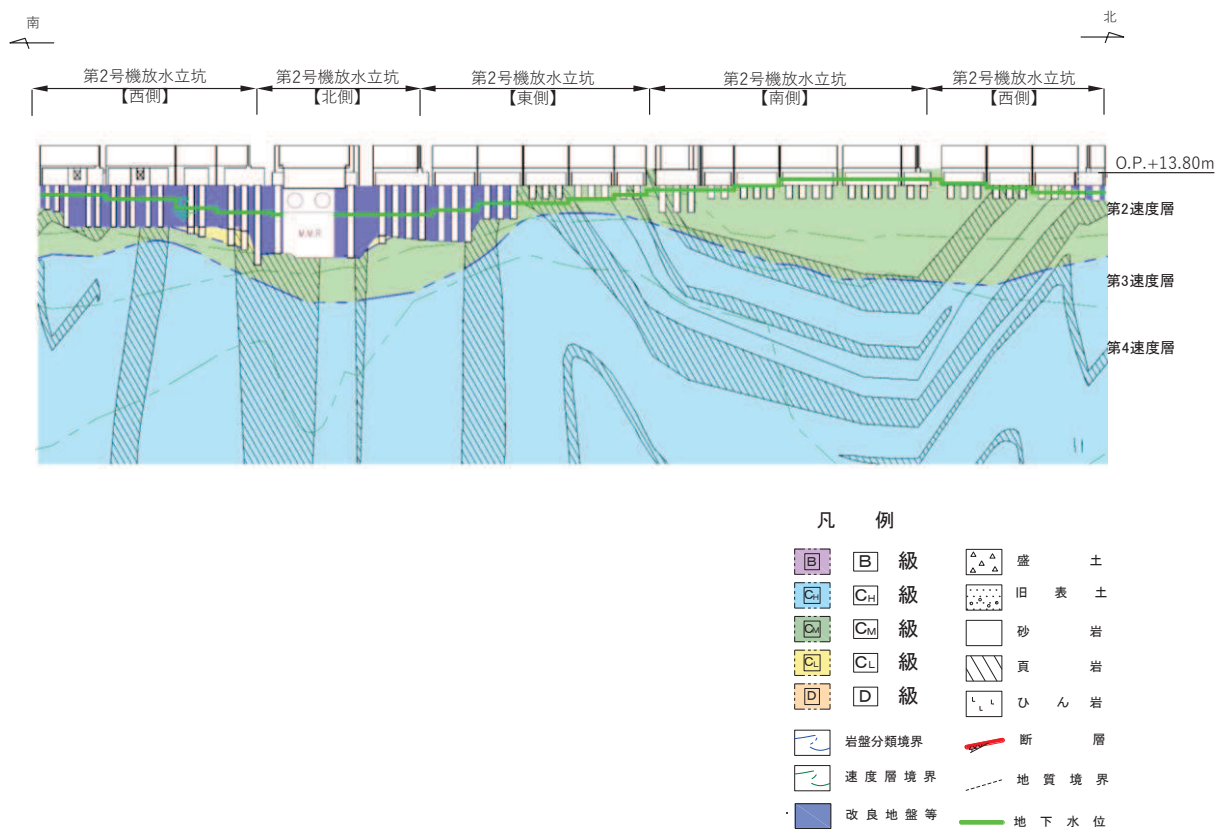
第2号機放水立坑防潮壁 地質縦断面図
